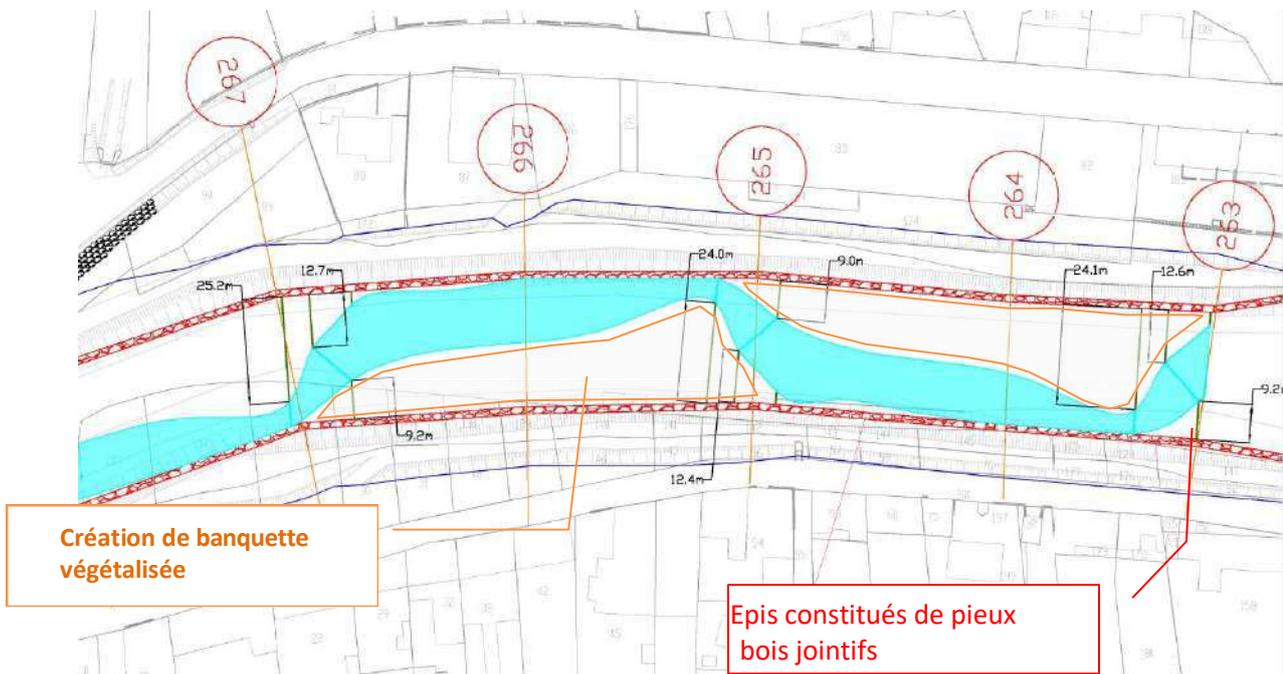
Extrait du plan d'implantation des déflecteurs dans la traversée de Bollène
